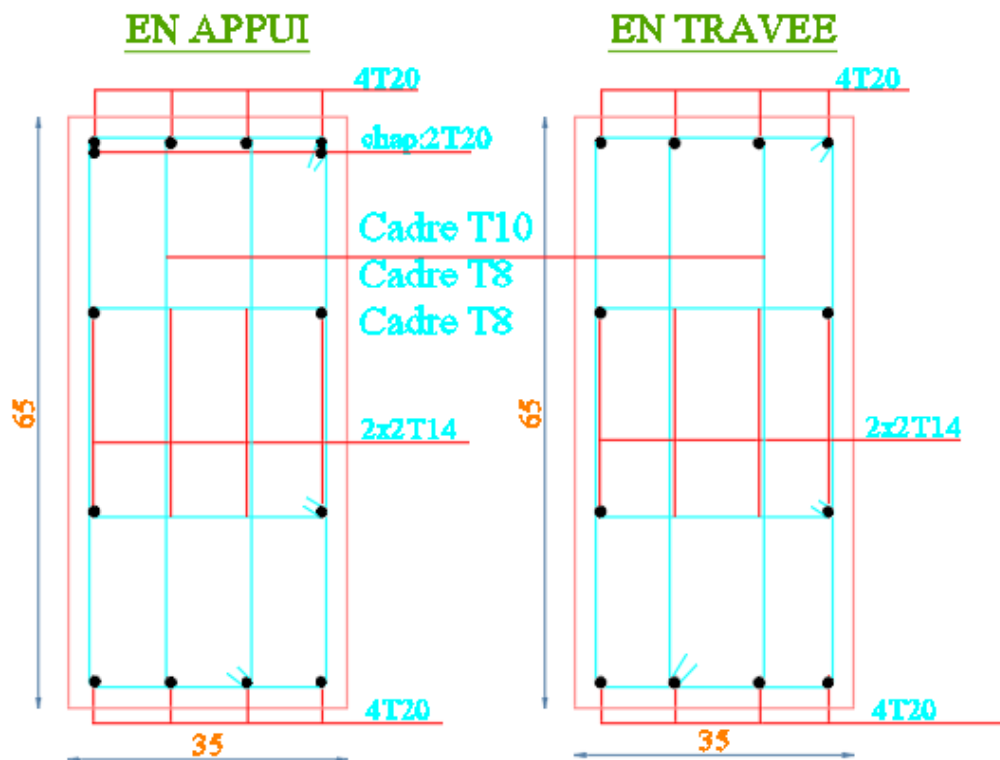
Schéma du ferrailage de la poutre secondaire 35*65
